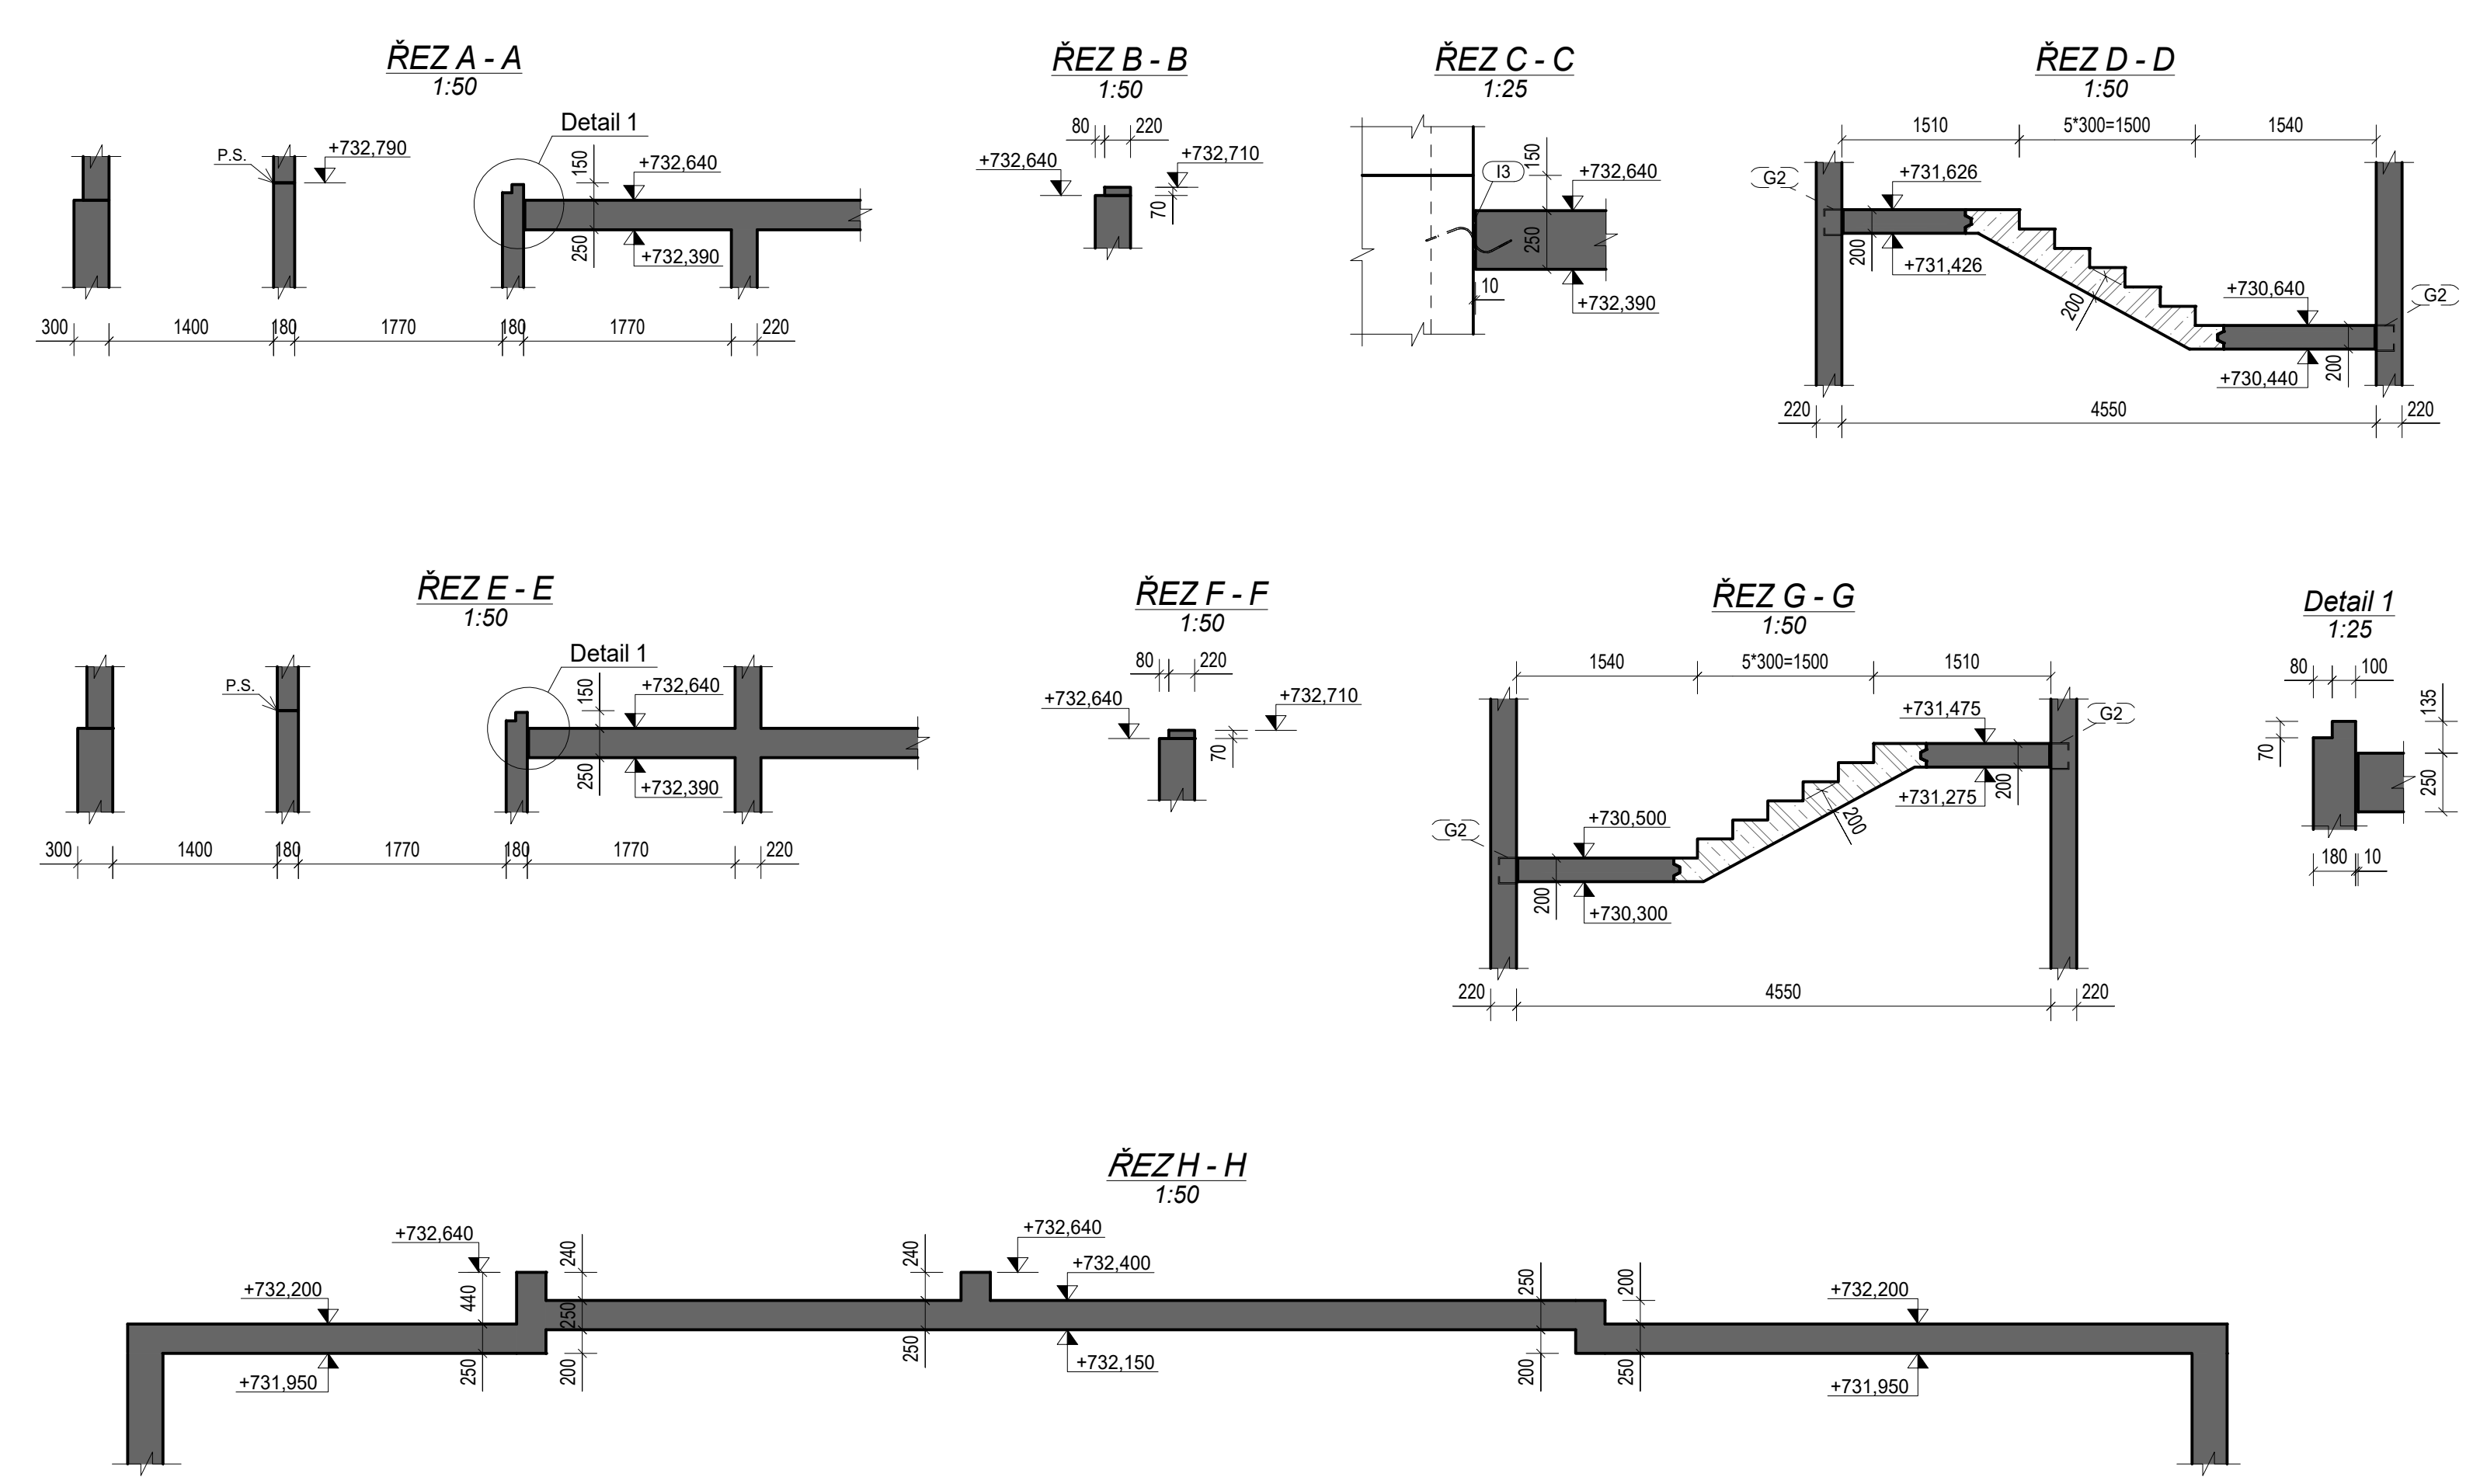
DETAILY - VODOSTAVEBNÍ KONSTRUKCE
